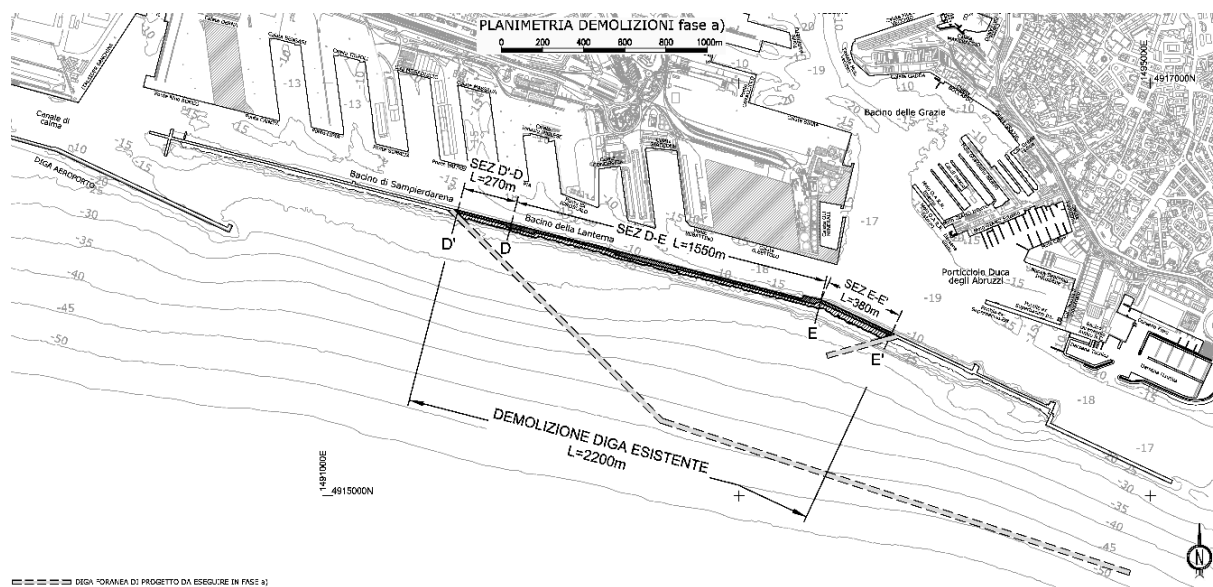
PLANIMETRIA DELLE DEMOLIZIONI PREVISTE IN FASE A)
